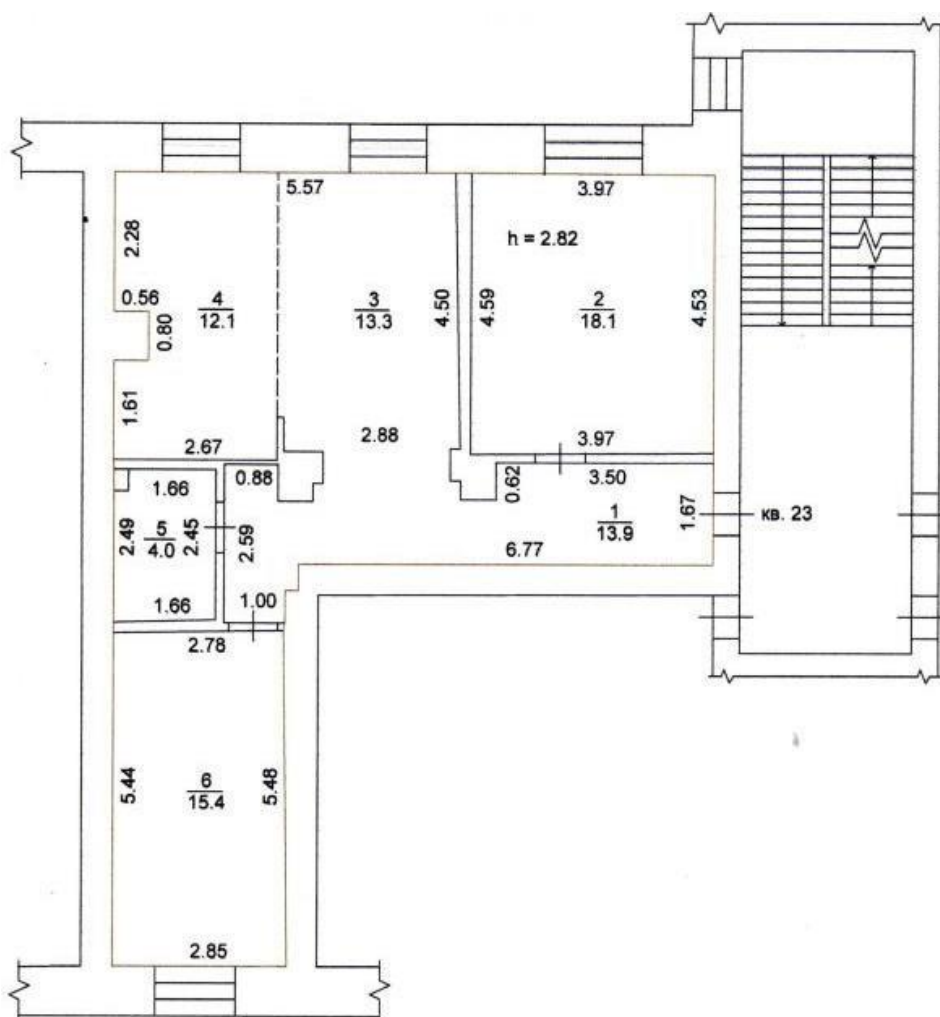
План квартиры после проведения перепланировки и переустройства.
